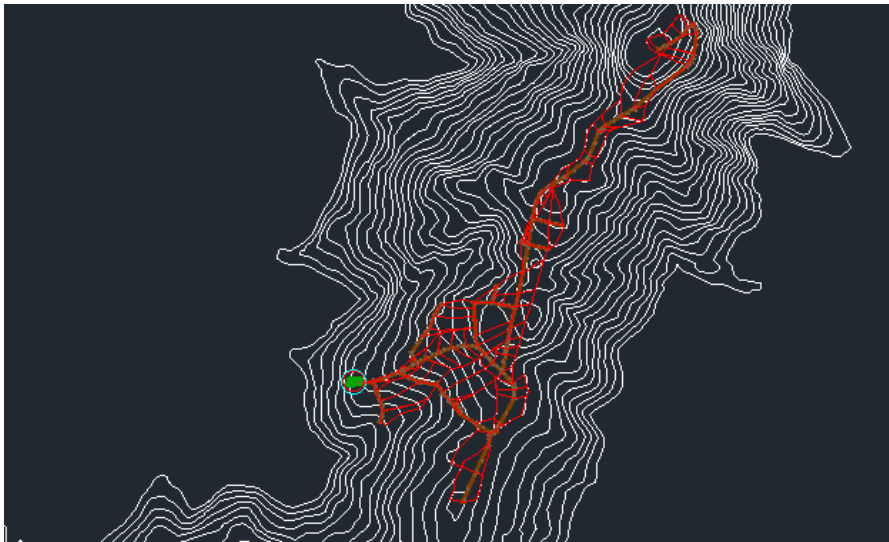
Áreas de aporte de la planta de tratamiento Cementerio.
